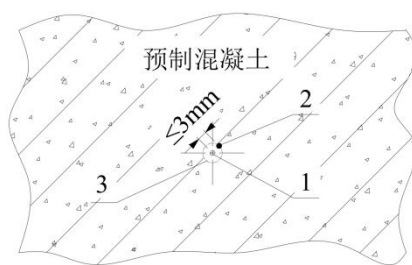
预制混凝土套筒预埋偏移误差要求
